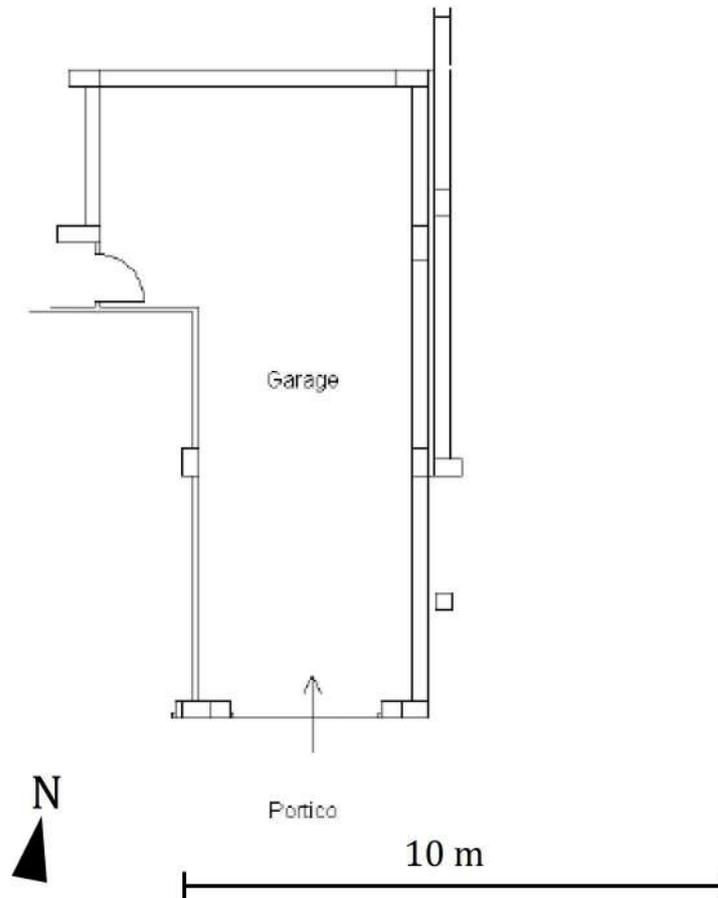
Estratto Planimetria Catastale - Foglio ■ Part. ■ Sub ■ - Piano S1° (garage annesso)
